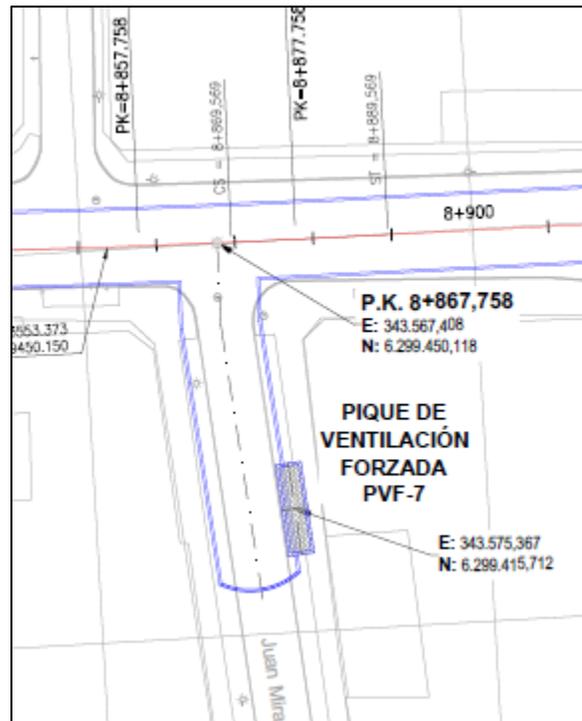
Planta Emplazamiento Pique Ventilación Forzada Juan Miranda
